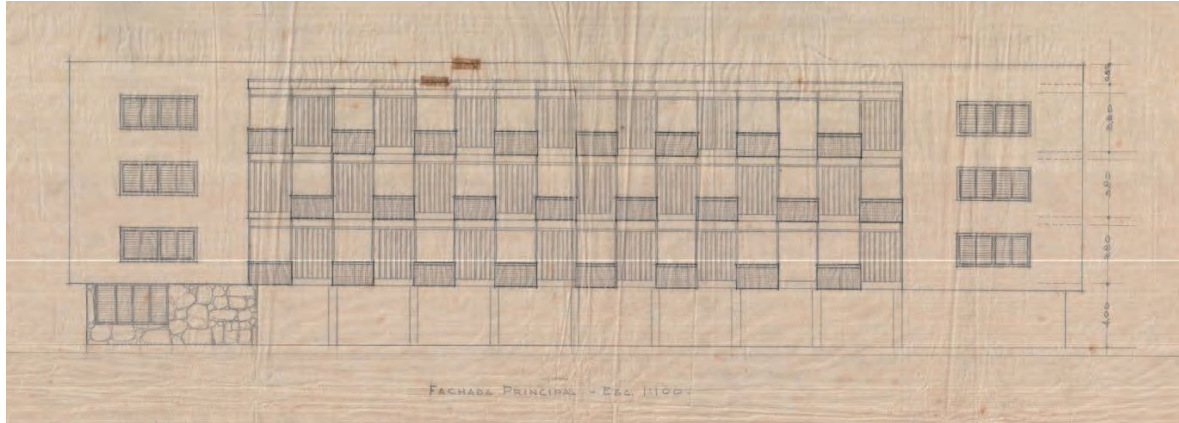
Plano original fachada del Colegio de La Salle (1955) – fachada al poniente – bloque administrativo. Dibujada a lápiz por el arquitecto Rafael Cepeda Torres. Fuente: Archivo Civilco Ltda.
